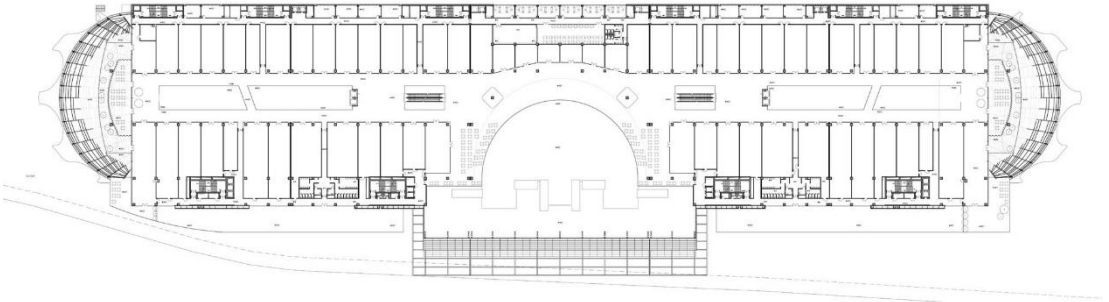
Ankara yüksek hızlı tren garı -1. kat planı (URL-11)
